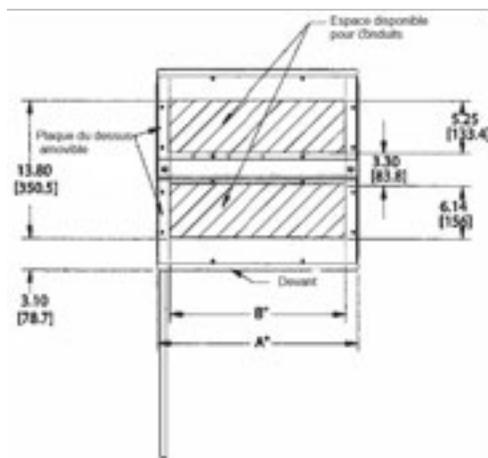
B. Espace pour entrée de conduits pour sections de 20" et 22"
